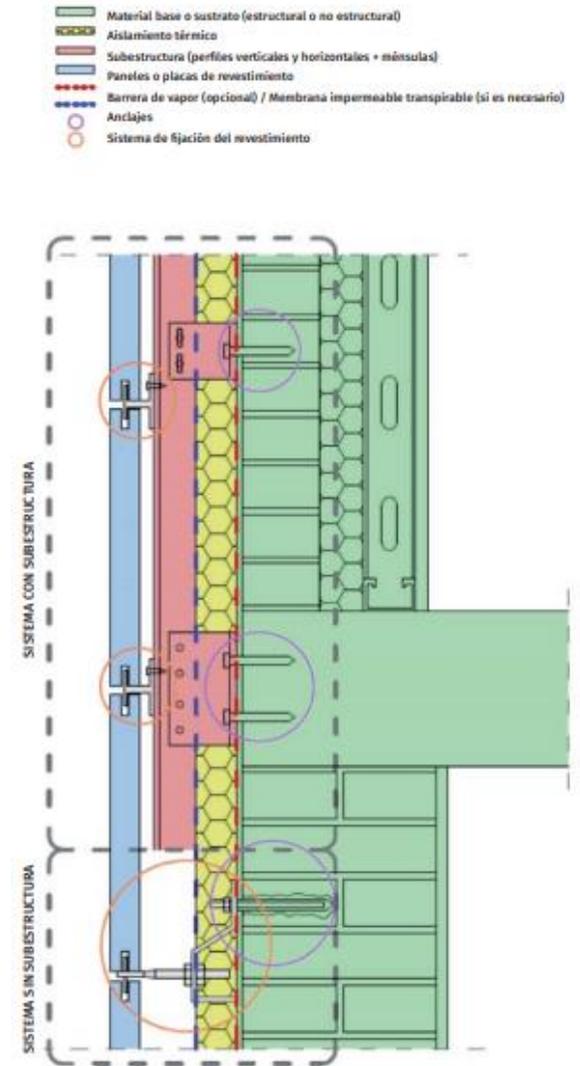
Componentes de fachada ventilada. Fuente: Manual de fachadas ventiladas de ASEFAVE
